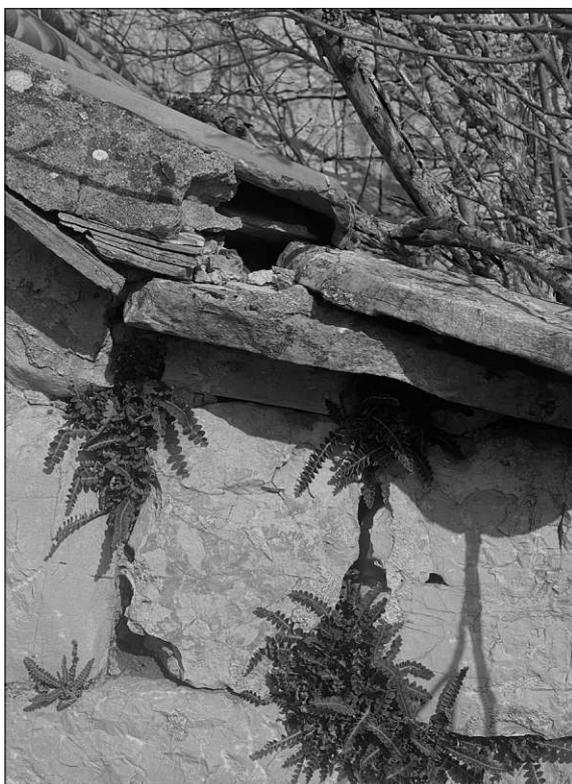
Das Dorf Dugobabe, Detail der Verbindung des Daches mit der farnbedeckten Wand
